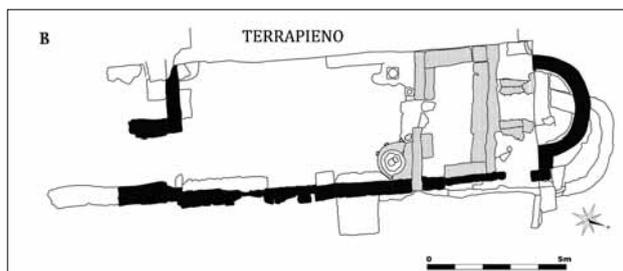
B - Massa di Faicchio, chiesa di S. Pietro. Planimetria delle emergenze con evidenziazione delle strutture riconducibili alla fase 3, di VIII-IX secolo.
